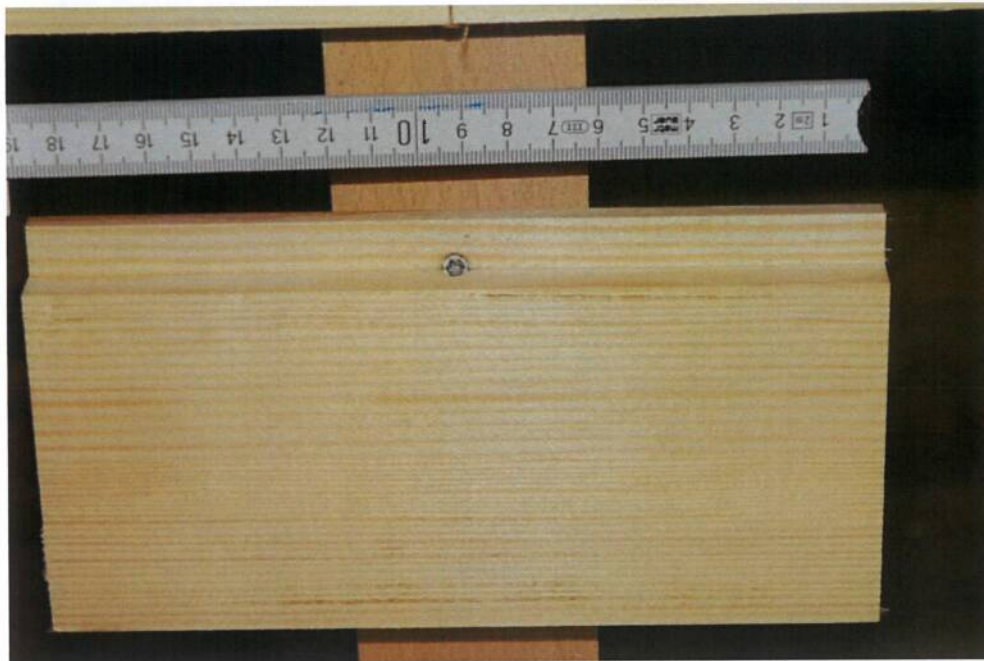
Situation 2 - Verschraubung mit SFS Doppelgewindeschraube WT-T 4,5x40mm
